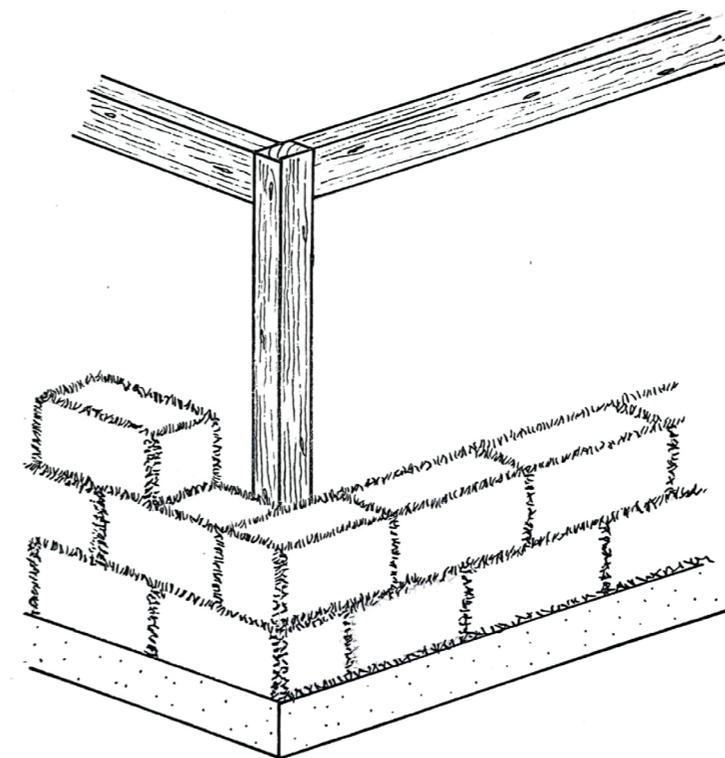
Sistema de postes y vigas (elaboración propia, 2023).
